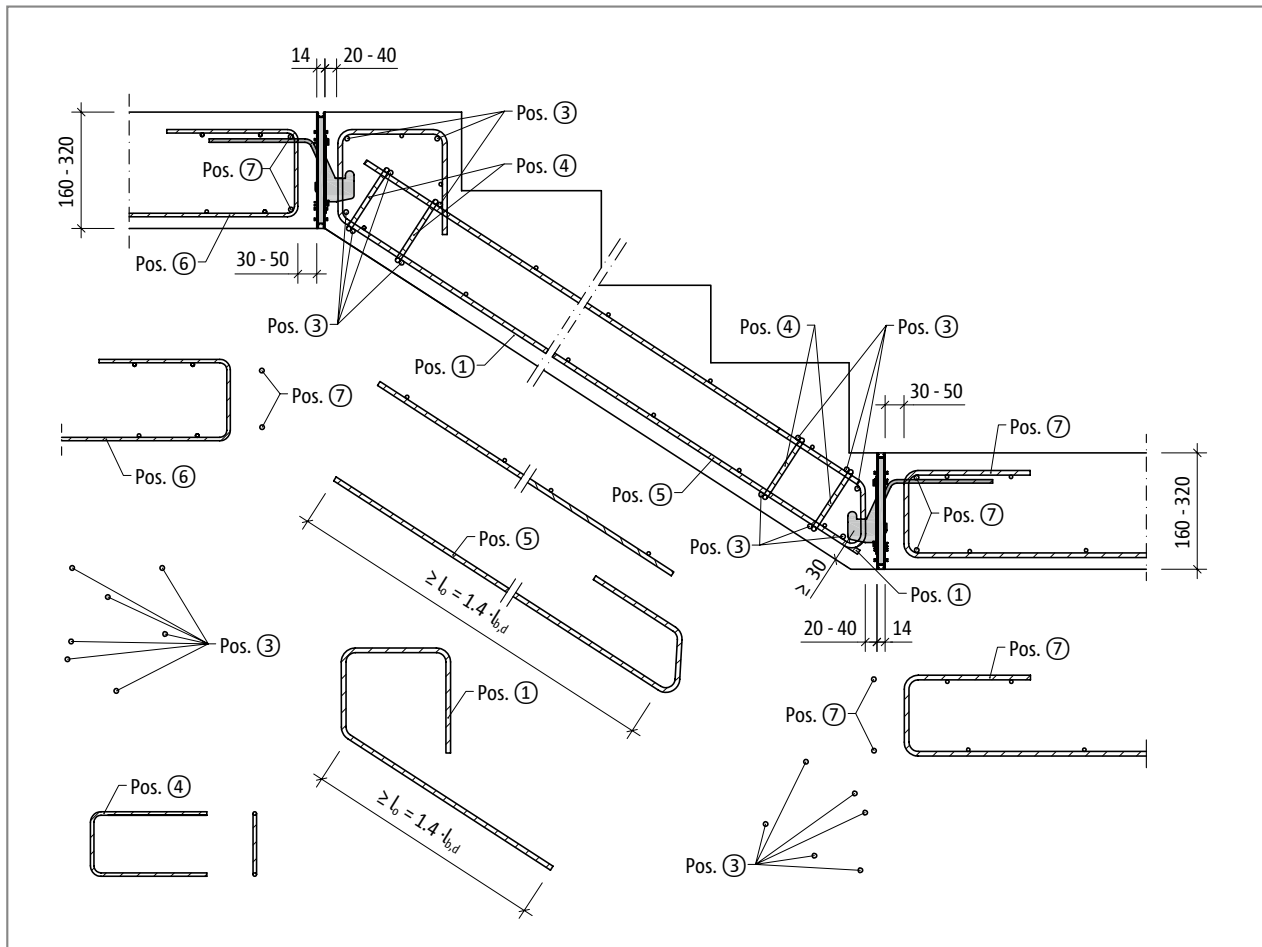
Schöck Tronsole® type T: On-site reinforcement
